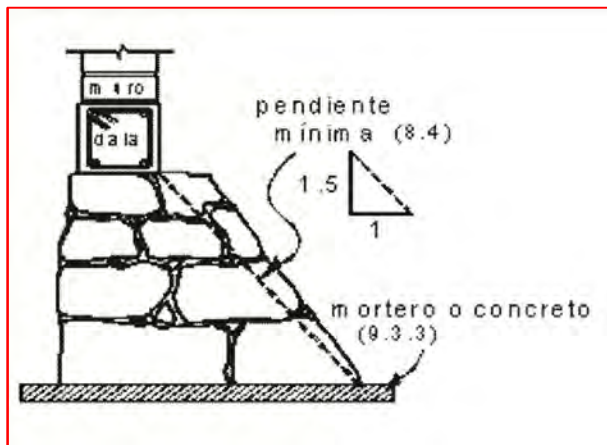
COORDINACIÓN CONTROL DE OBRAS Y PROYECTOS, S.A. DE C.V. (2013), MAMPOSTERÍA CONFINADA
